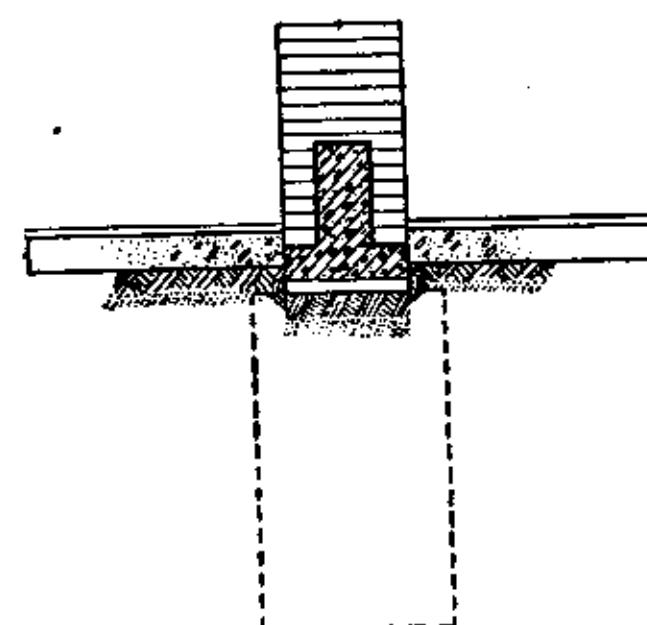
Железо-кирпичная randбалка и утепление пола
